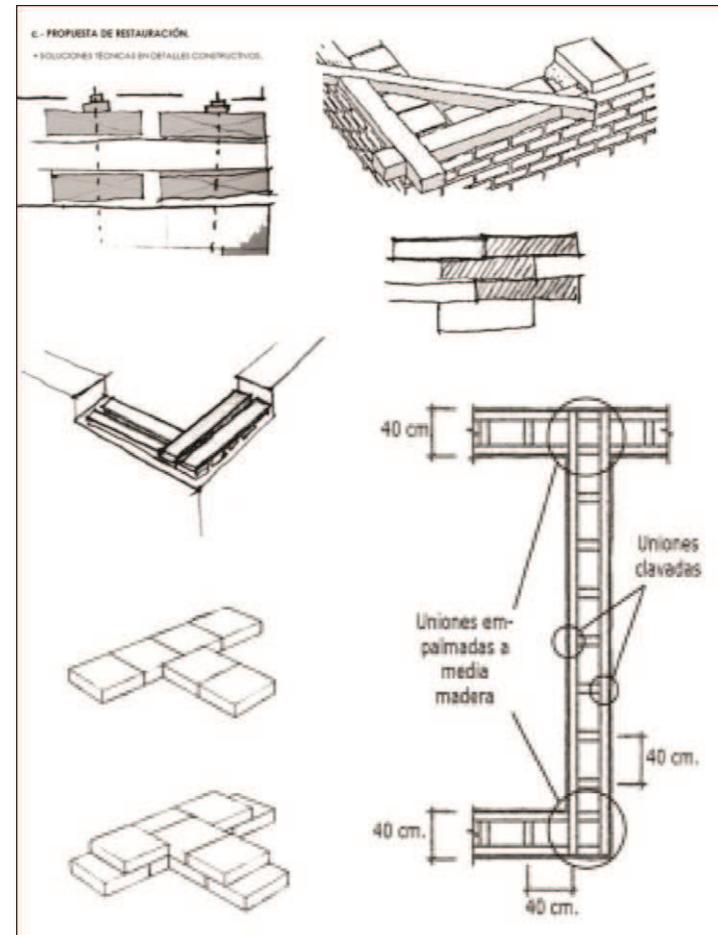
Detalles Estructurales de Sistema de construcción de Adobe
